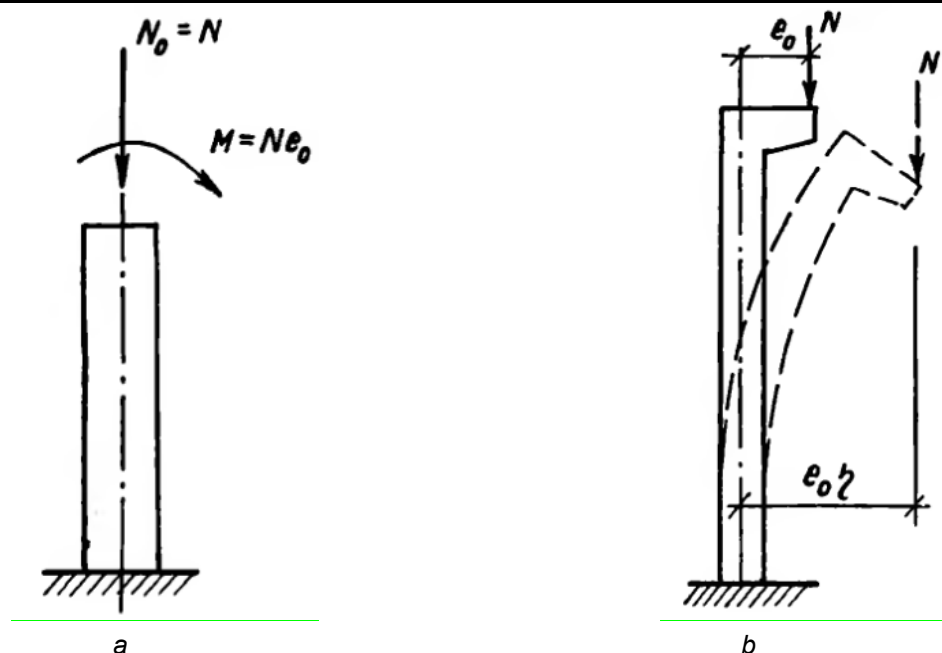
Внецентренно сжатые колонны железобетонного каркаса:
